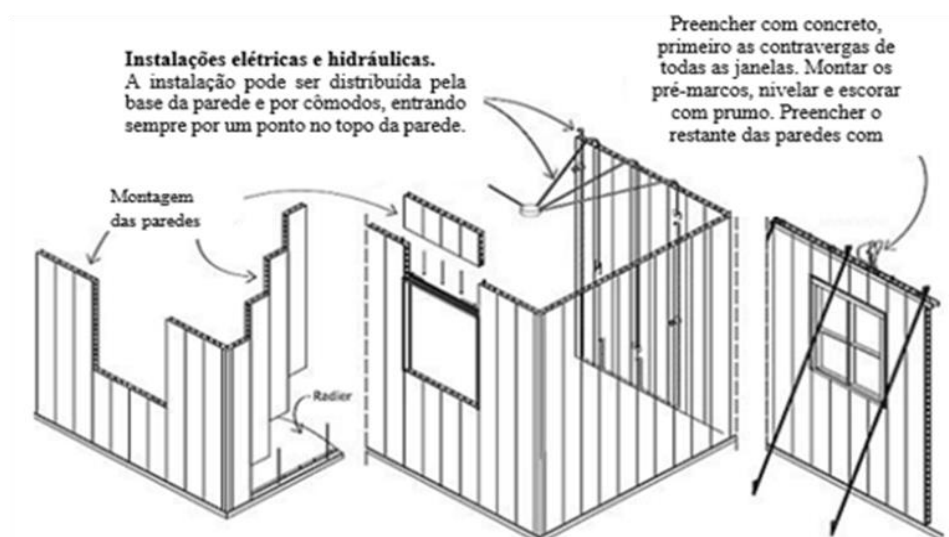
Sistema construtivo PVC e Concreto – Instalação em obra tipo habitação.
